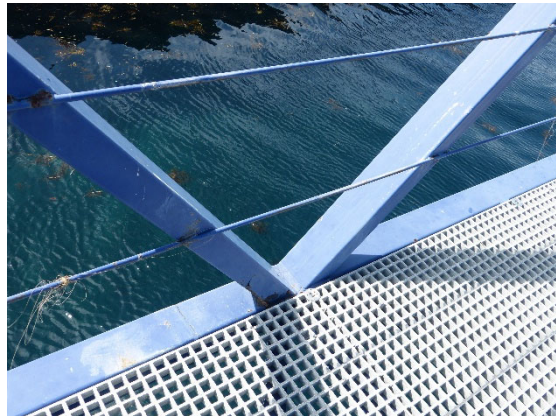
Inicio oxidación en soldadura del nudo 17A.
